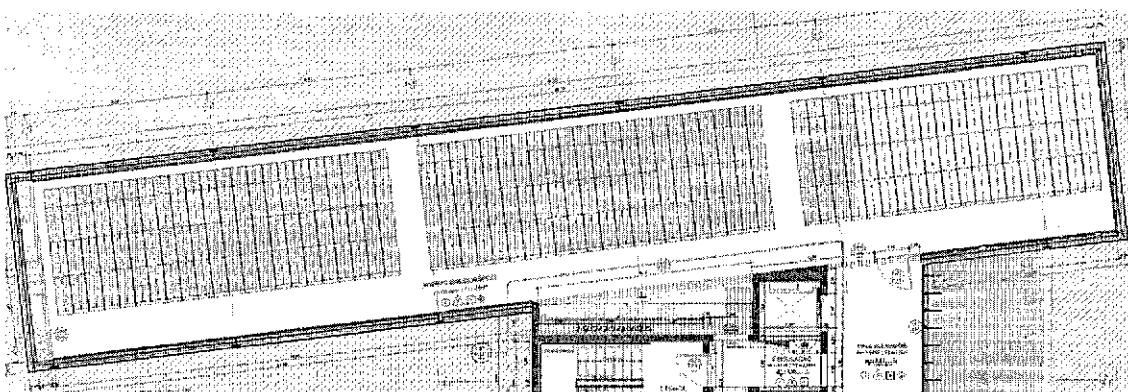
planta do 3º pavimento do objeto licitado, com área de arquivo com 175,00m².
